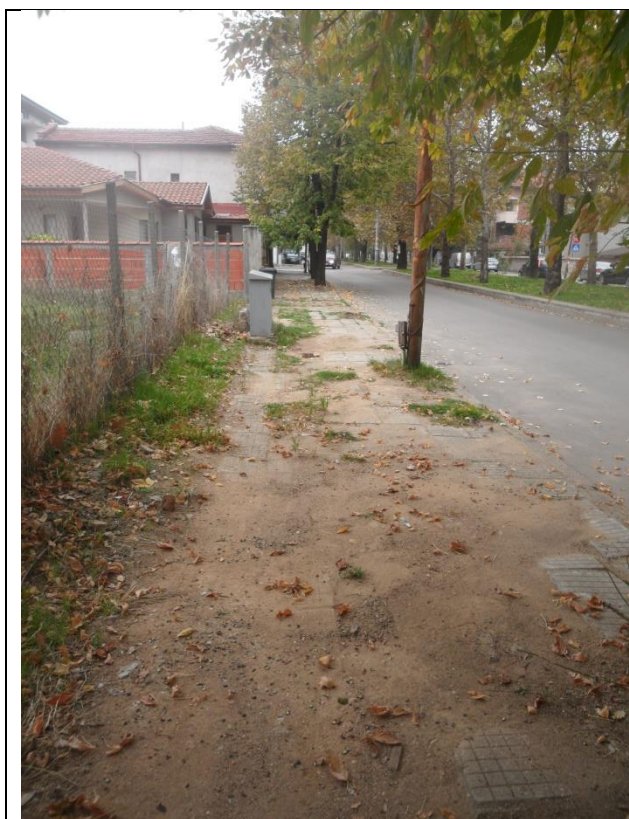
Broken sidewalk flooring /. Нарушена тротоарна настилка
